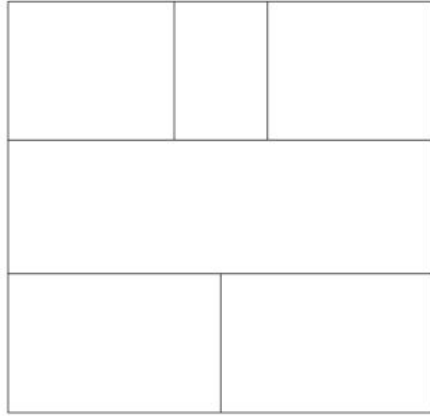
Dış Sofalı (Sekili Köşklü) Plan Tipi
